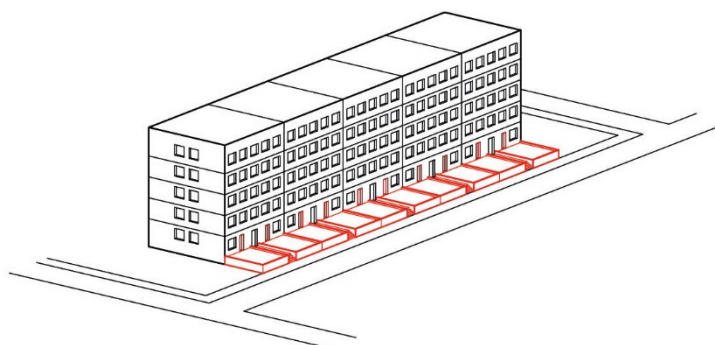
příklad úpravy „zdola“: Kupchino, Petrohrad, Rusko (Zdroj: Molnárová)
